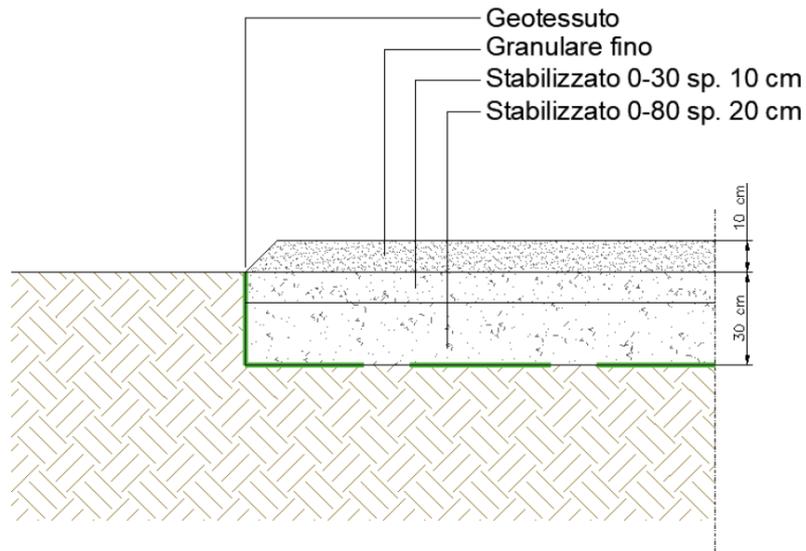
Sezione tipo viabilità interna all'impianto e piazzali
